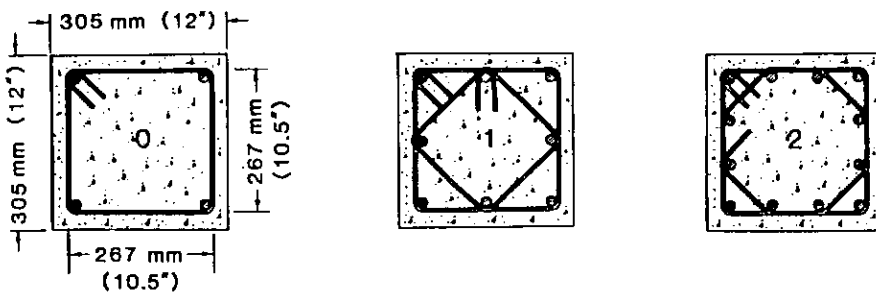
Configurações de armaduras longitudinal e transversal utilizadas por Uzumeri e Basset ao pesquisarem a ductilidade de pilares de concreto [44].
